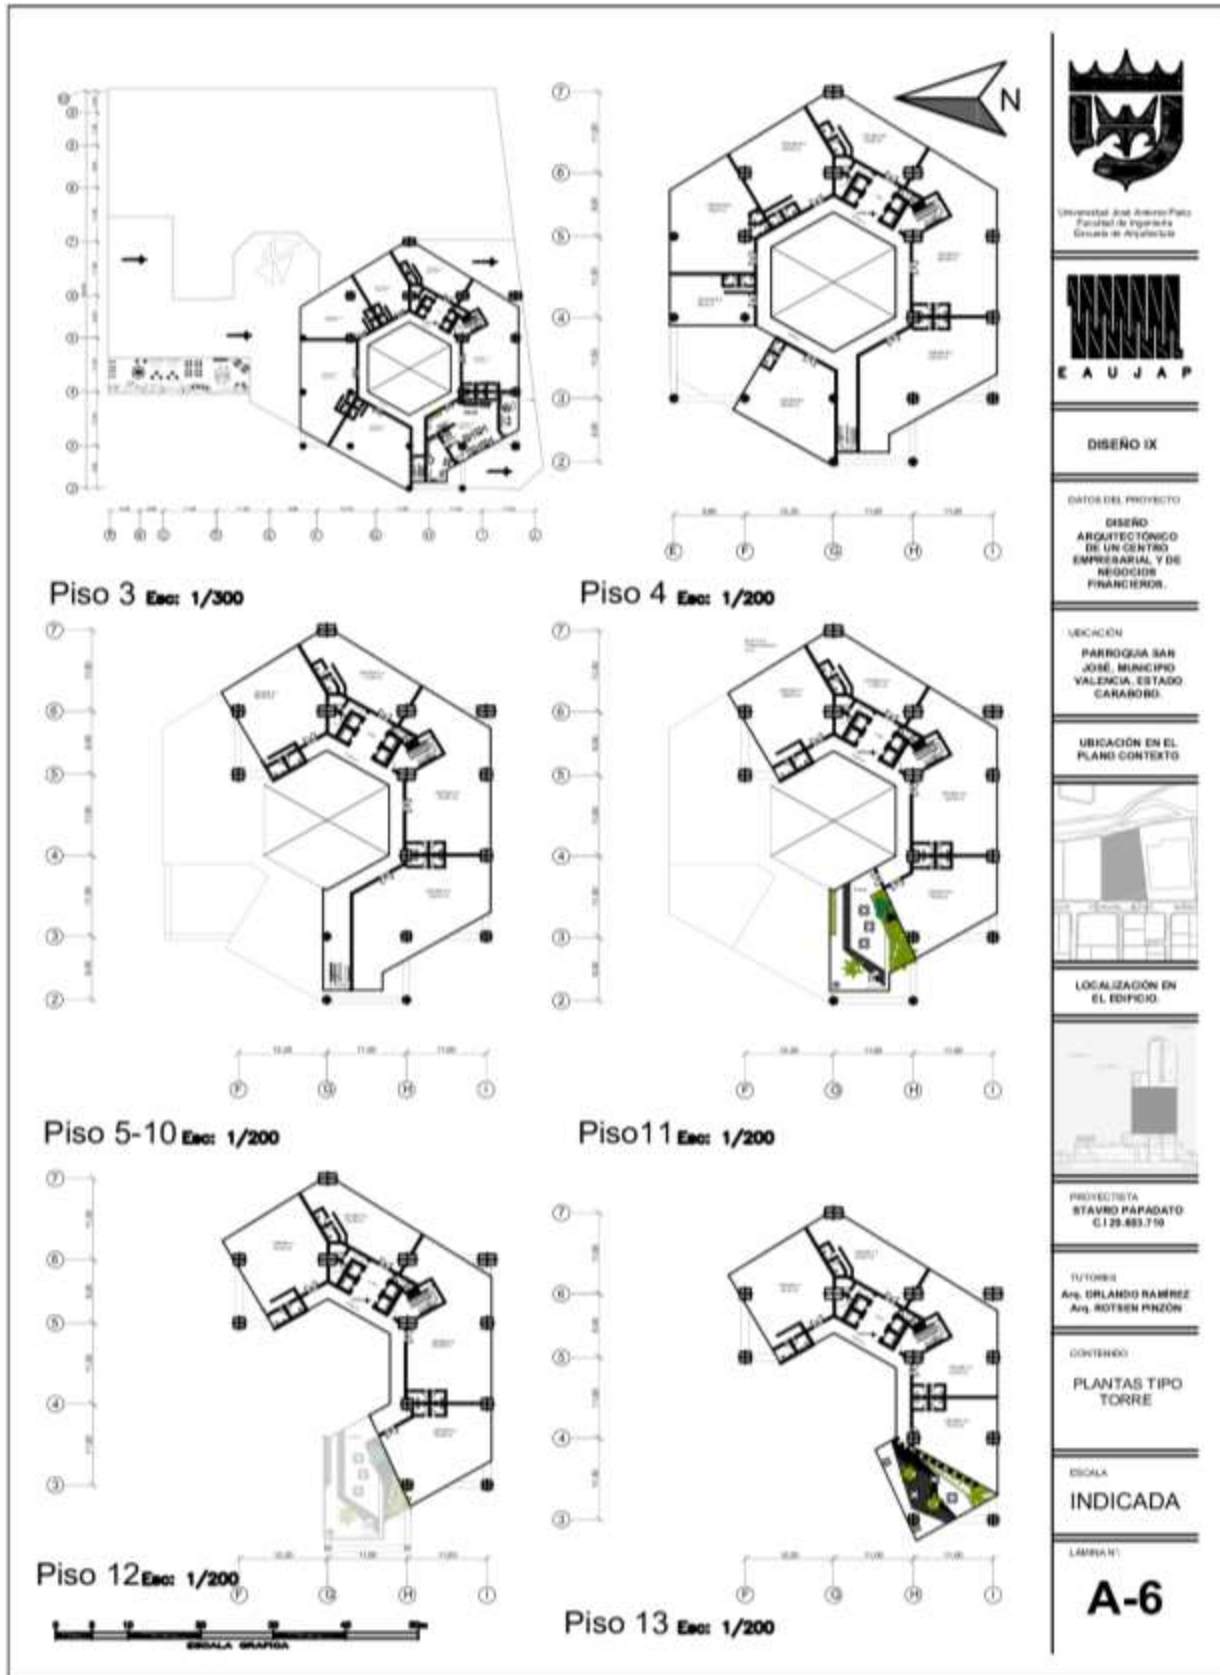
A – 6 Plantas Tipo Torre Piso 3 hasta el Piso 13 Fuente: El Autor (2023)
